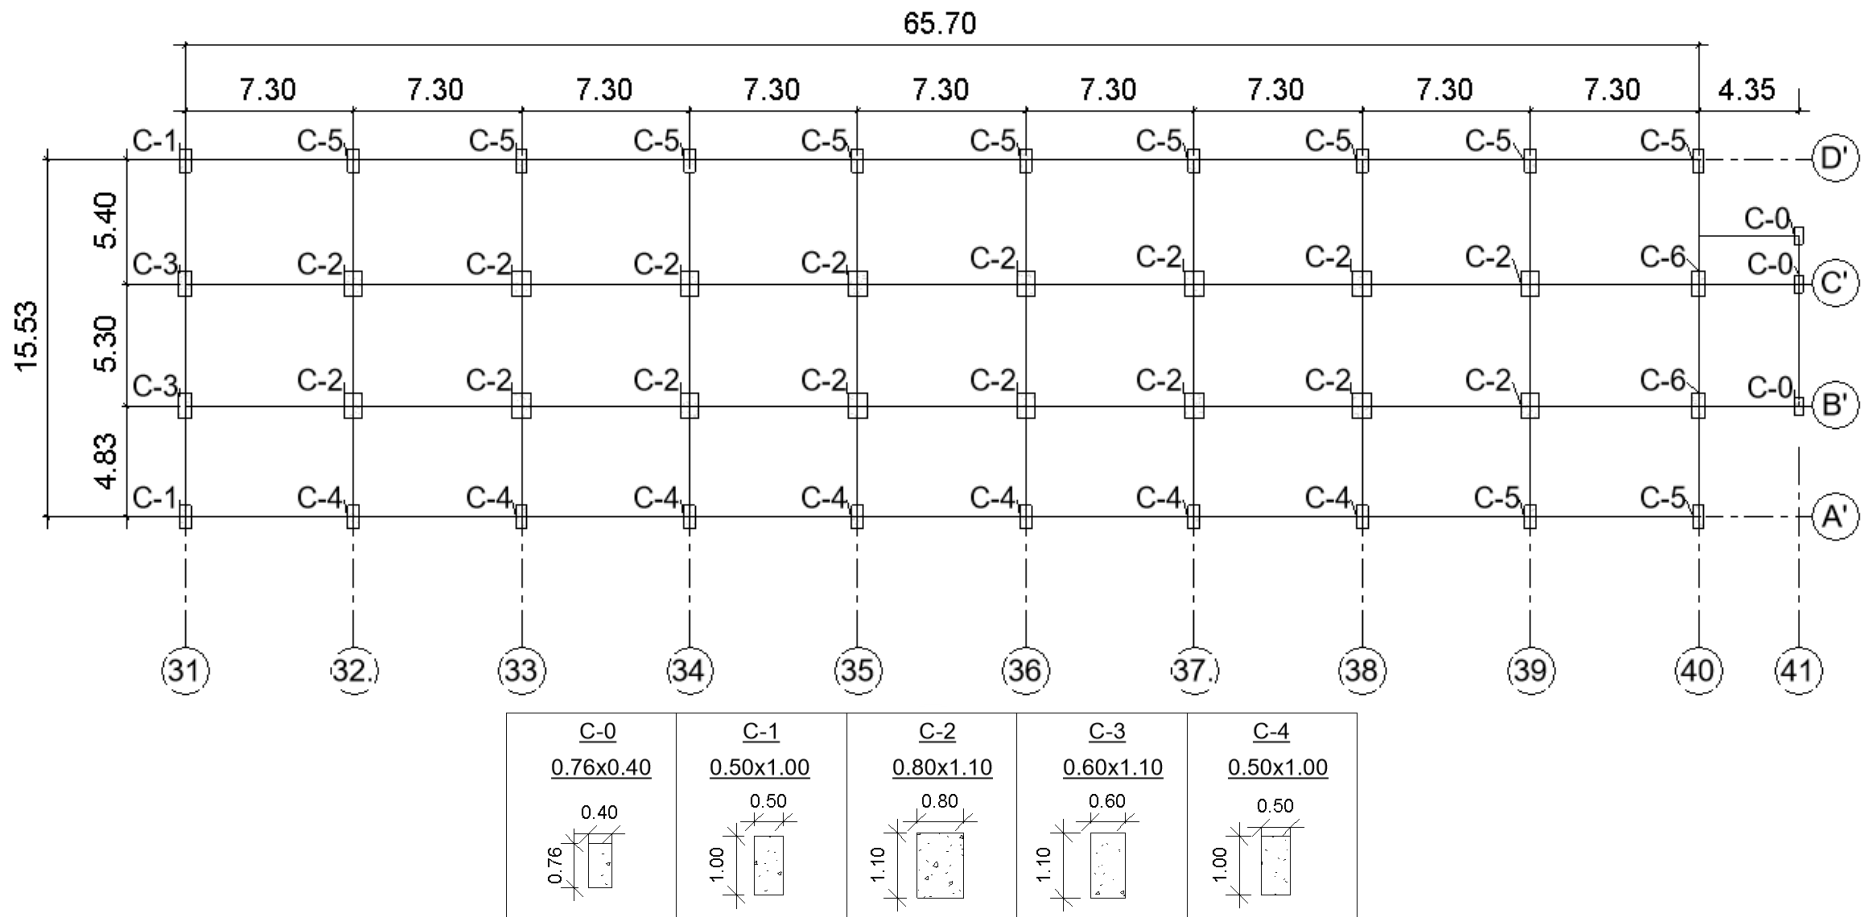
Planta Típica de la edificación (Pabellón C)
